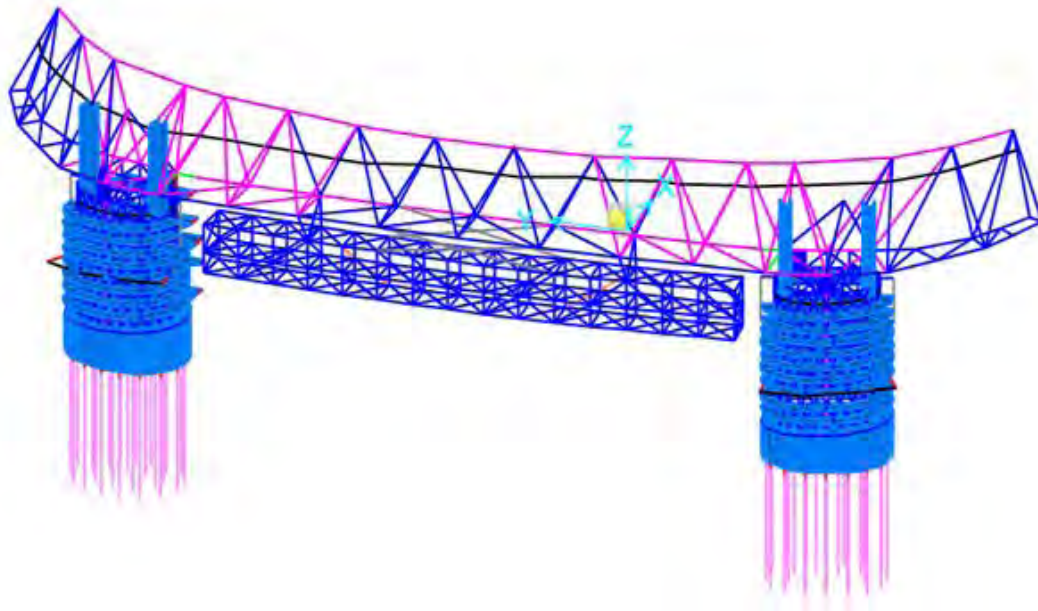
Modelo de cálculo para diseñar los elementos de hormigón de las torres.
